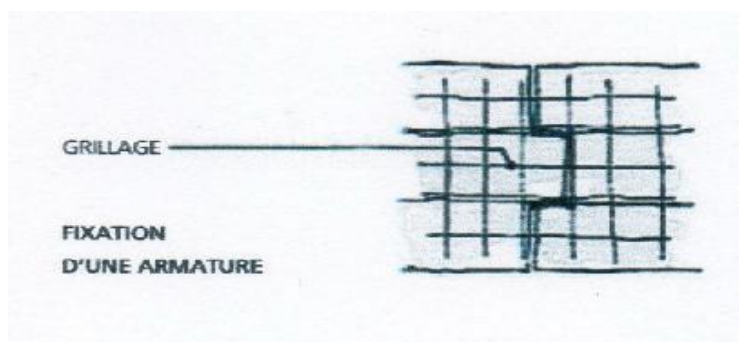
Fixation d'une armature sur la zone fissurée d'un mur en pierre
